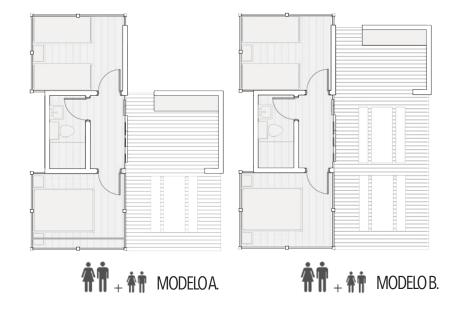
Viviendas de Emergencia Modelos A & B Fuente: Elaborado por autor
